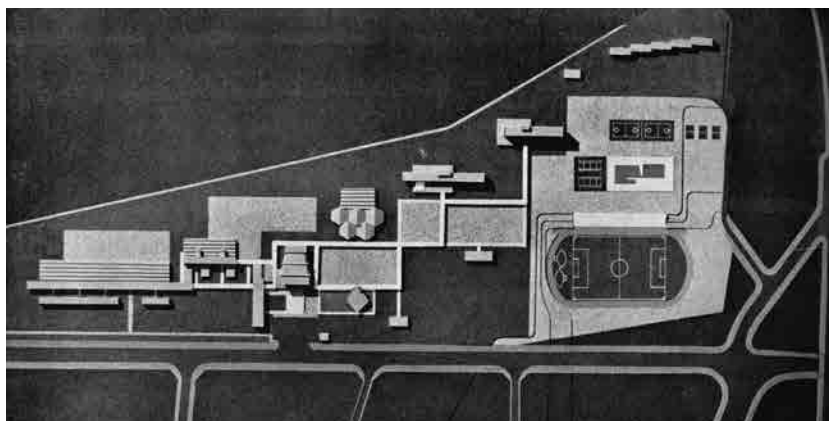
Segundo premio. Vista de la maqueta en planta. Fotografía de época.
